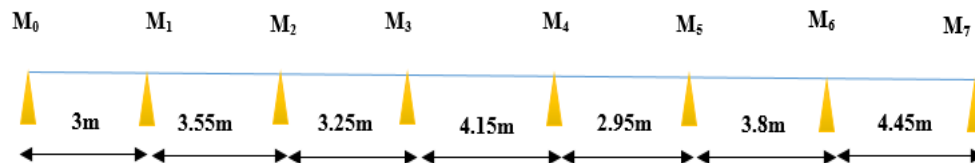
8: Coupe transversale de la poutrelle à 7 travées.
